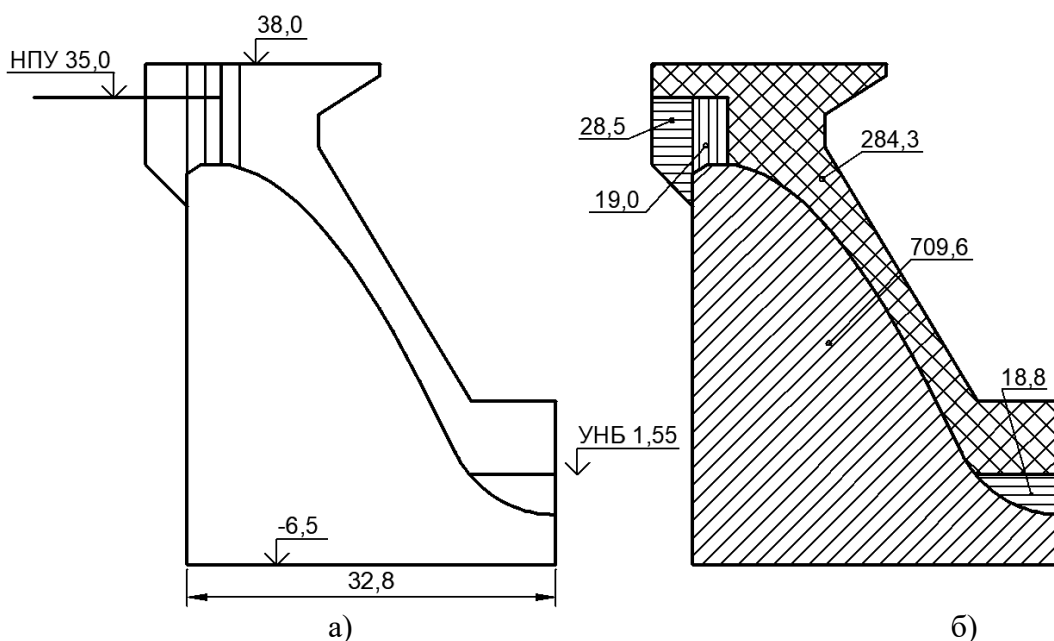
Исходные данные к расчёту нагрузок на бетонную водосливную плотину
